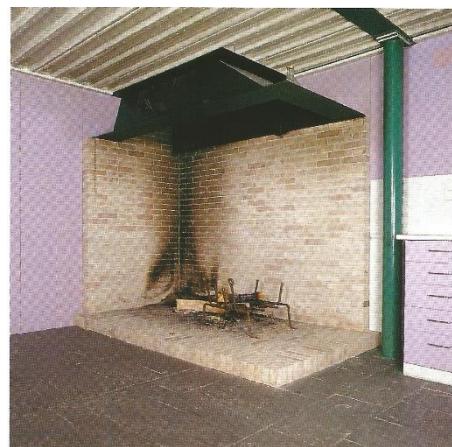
Chimenea en planta baja [Libro Casas de montaña]
